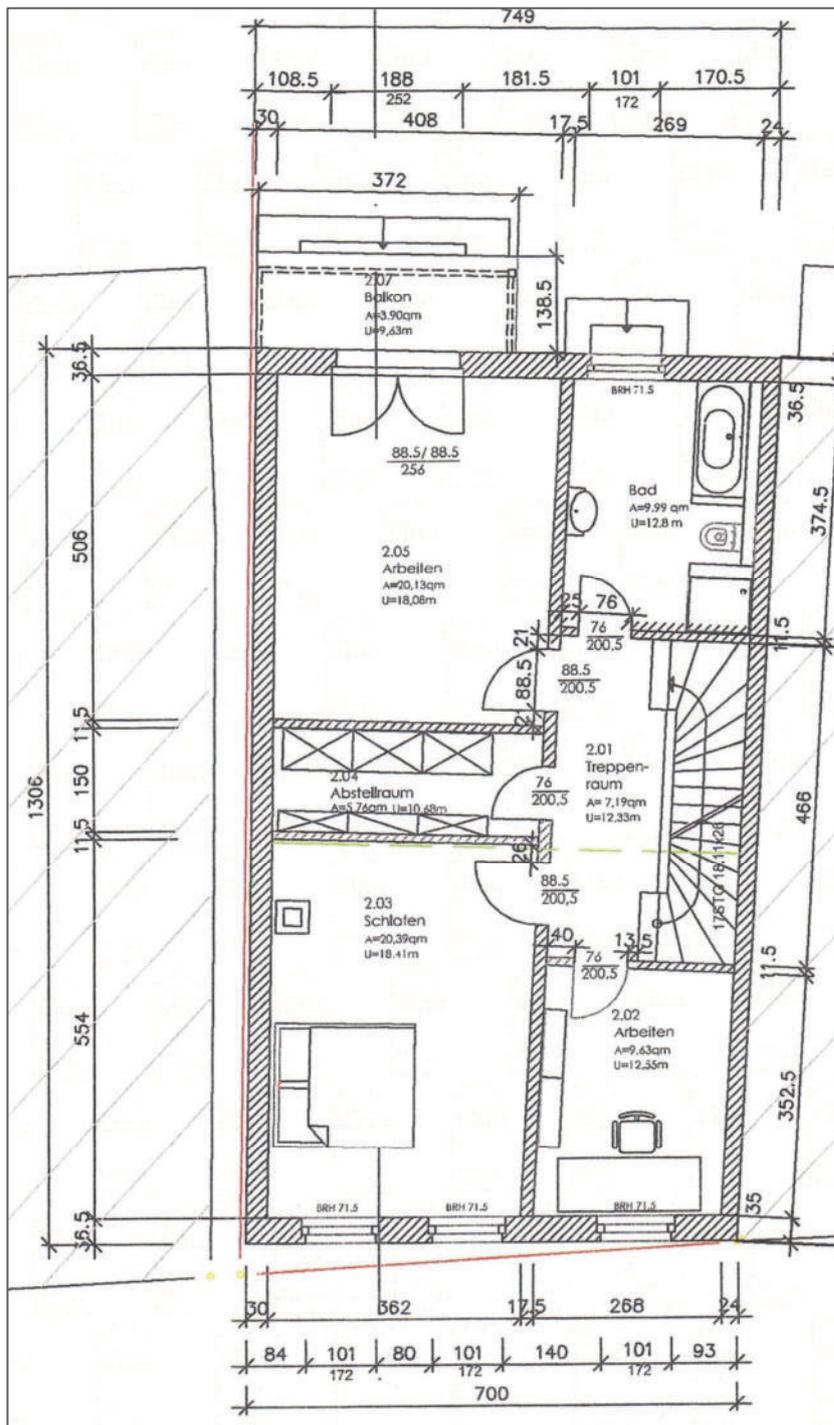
Grundriss obere Etage - Durchgangstreppenflur Reihenhaus in Neubrandenburg, Kleine Wollweberstraße 9 (Peggy Bahmann)
